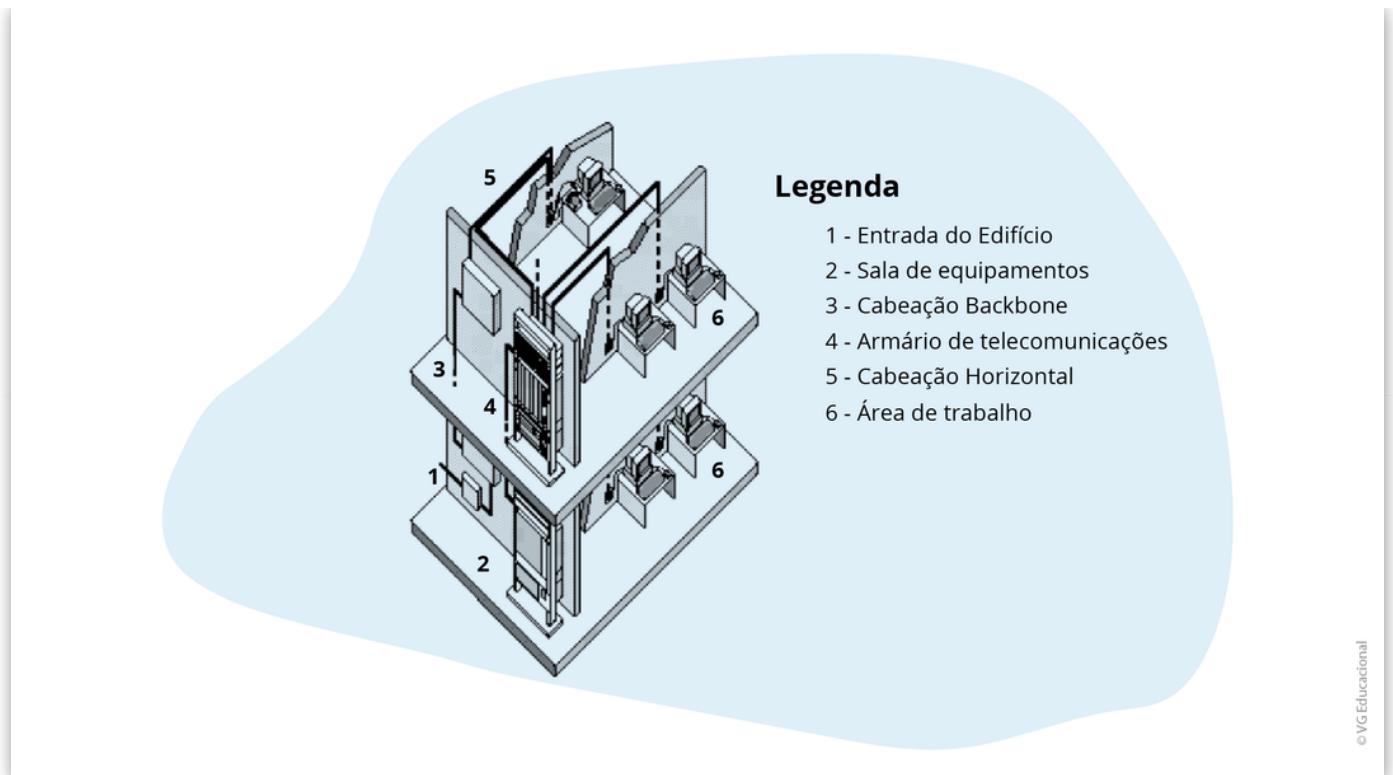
Disposição do cabeamento estruturado em um prédio
